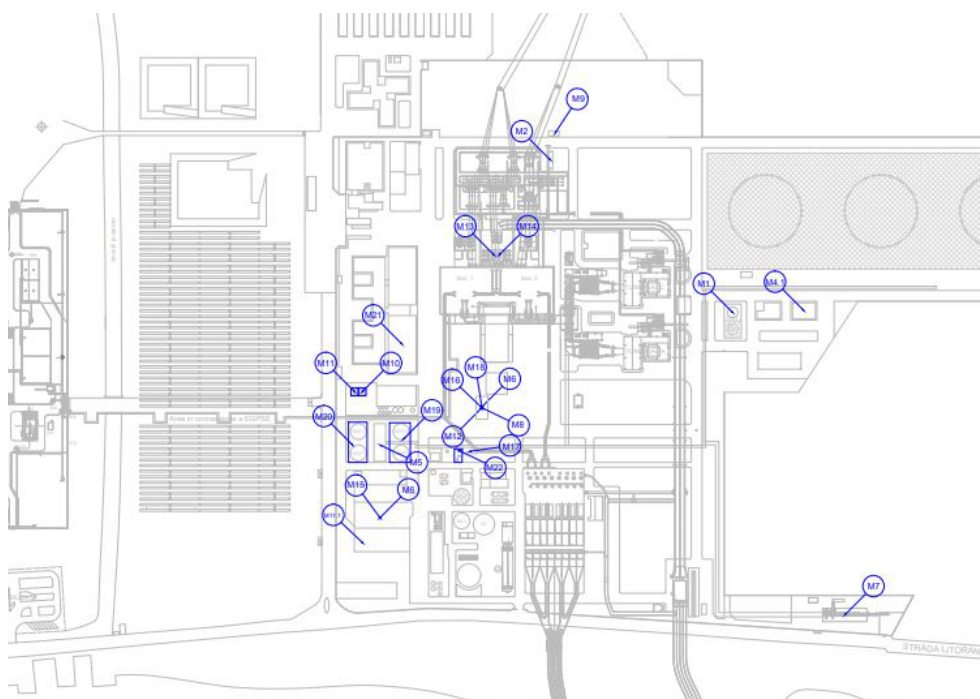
Planimetria dell'installazione con individuazione del posizionamento dei container
